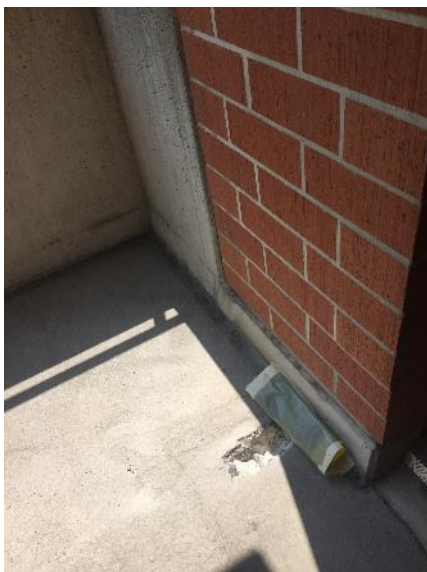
Balkonelement mit Abplatzung (Erdgeschoss, linke Ecke Süd-West-Fassade)
